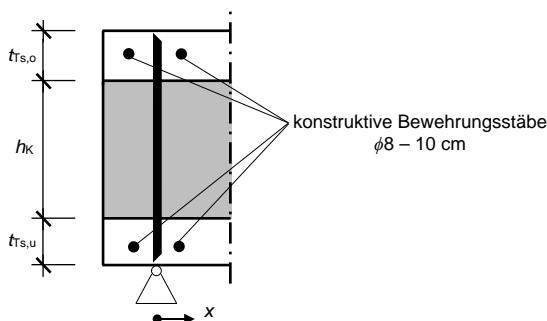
Ausschnitt eines Sandwichelementes mit Darstellung der konstruktiven Bewehrung für das Verbundmittel über dem Auflager
